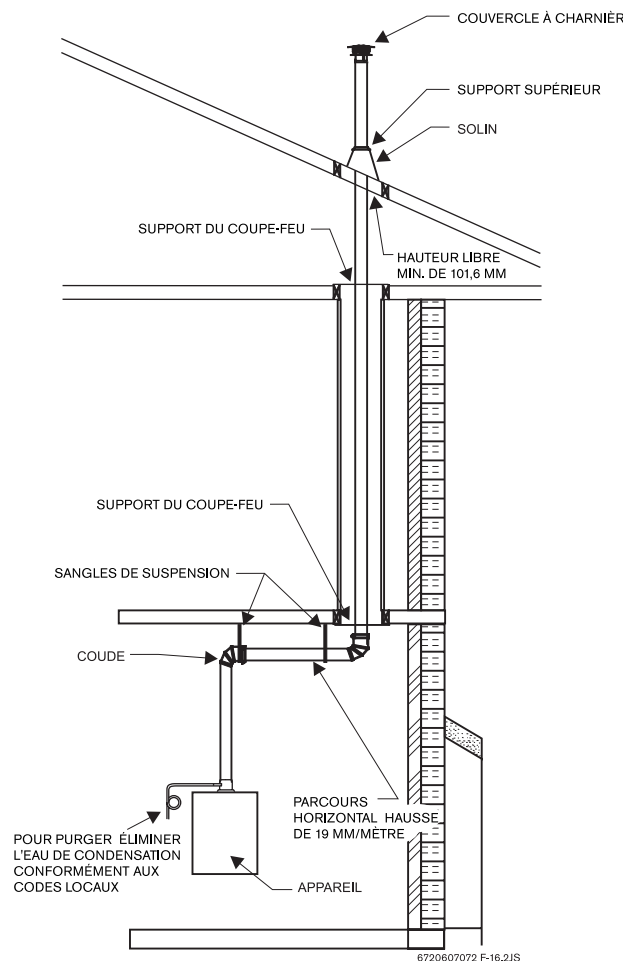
Installation du conduit à la verticale ((conduit d'air comburant non illustré)
